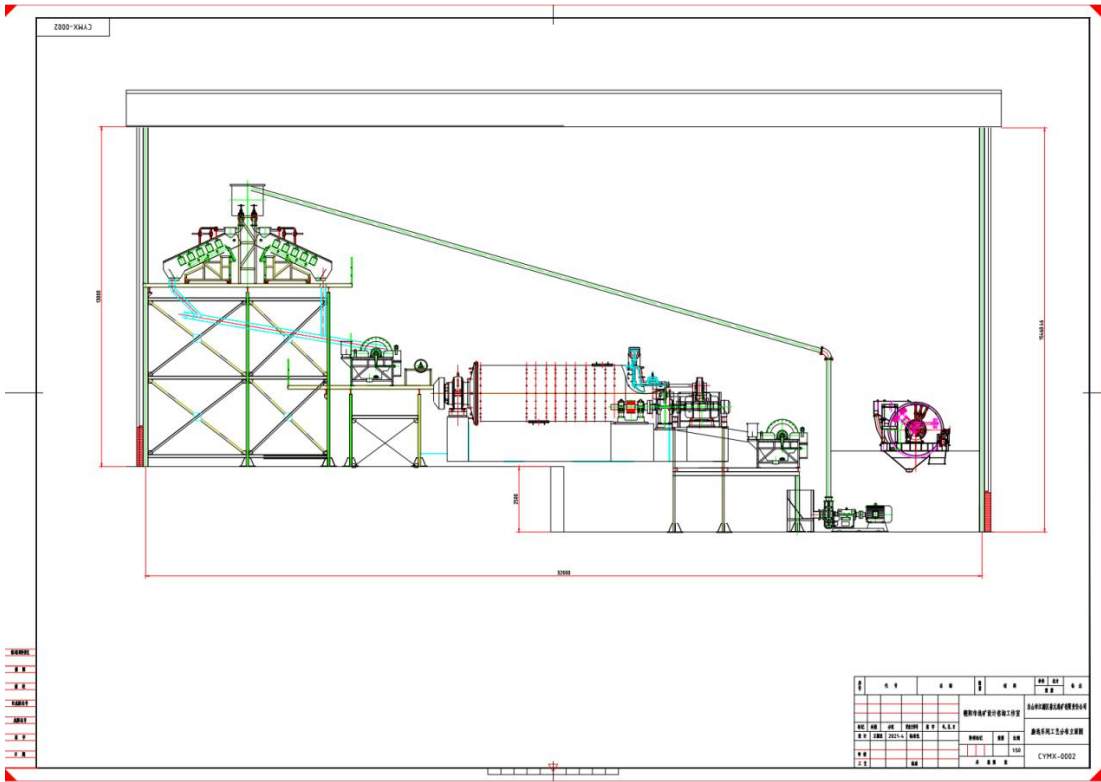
改扩建后选矿车间工艺分布立面布置图
